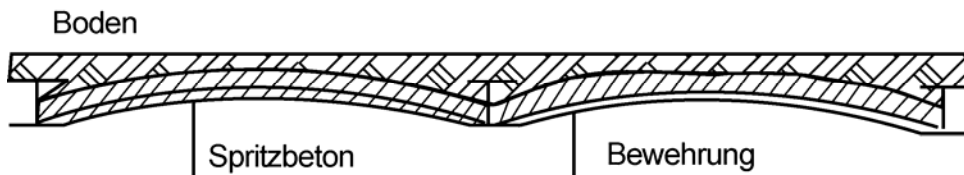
Spritzbetonausfachung mit Bewehrung [5]
